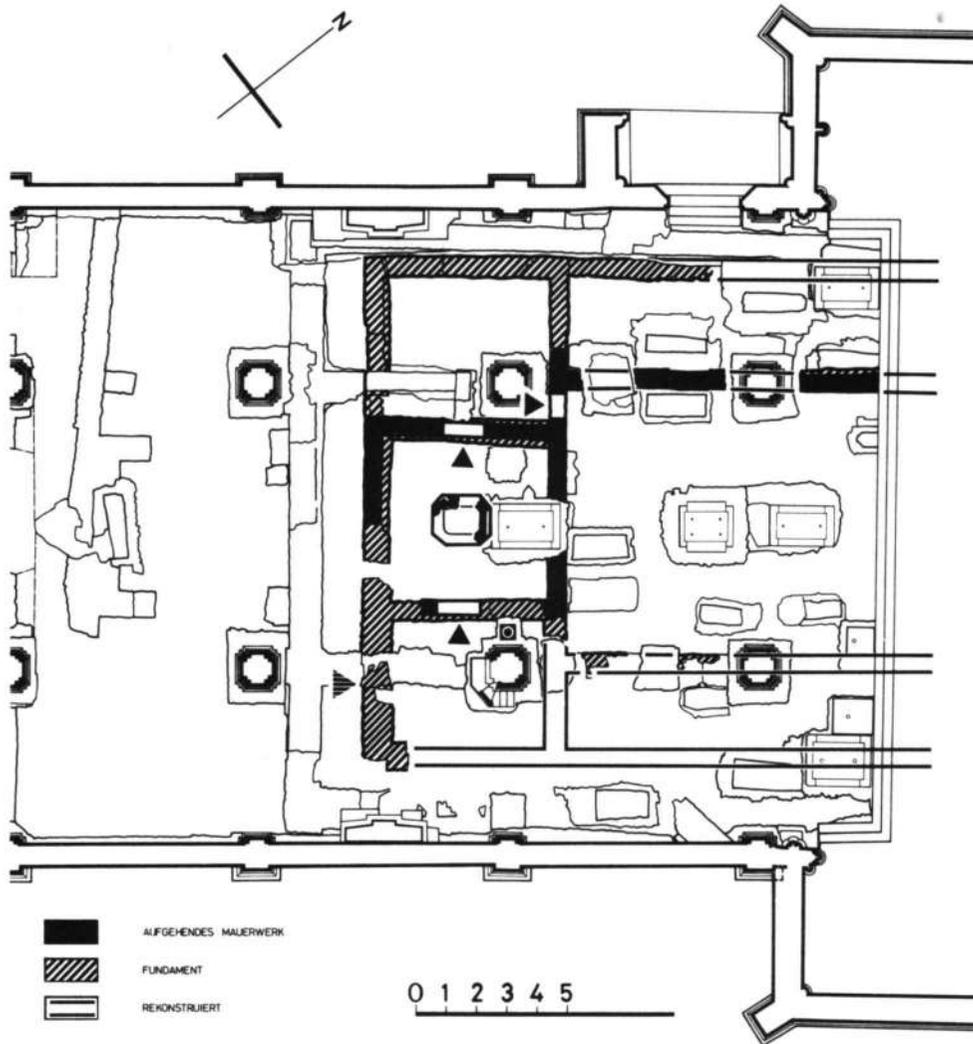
Anlage I: rekonstruierter Grundriss (Massstab 1 : 250).
